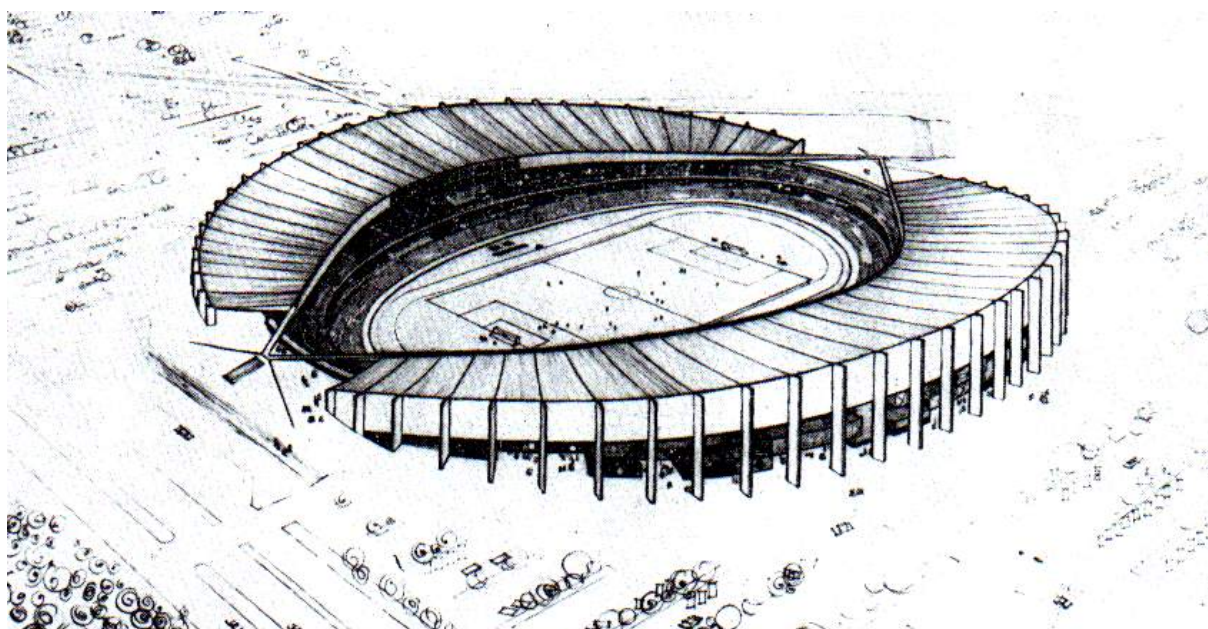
1º prêmio concurso Estádio Pinheirão: vista em elevação da maquete (face leste);
